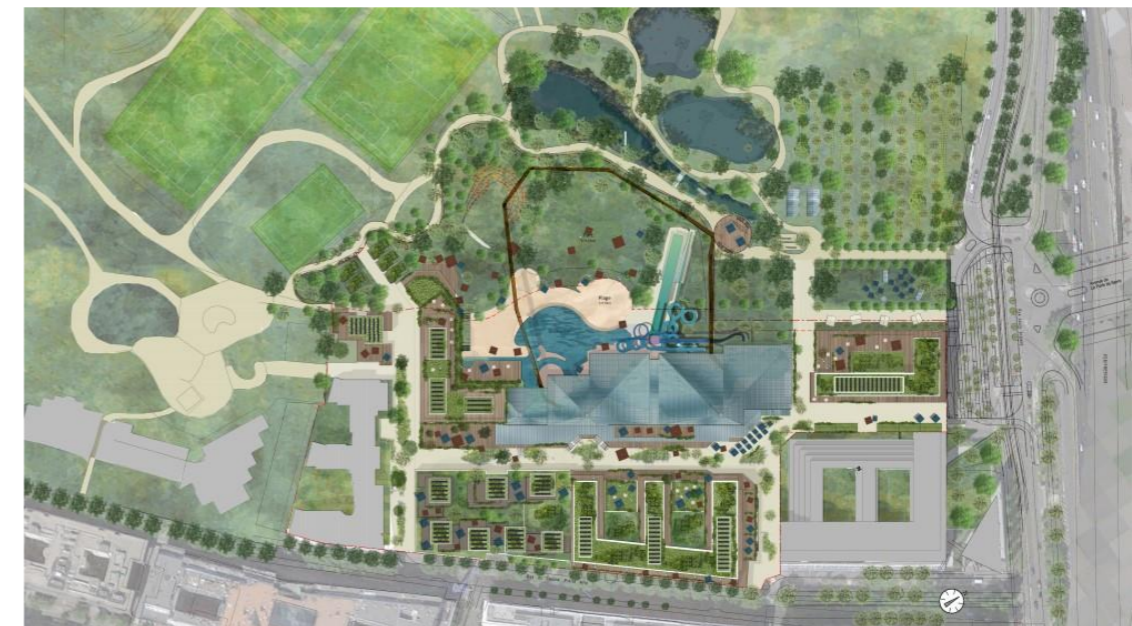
Proposition plan masse, mai 2021 (Source : WO2)
